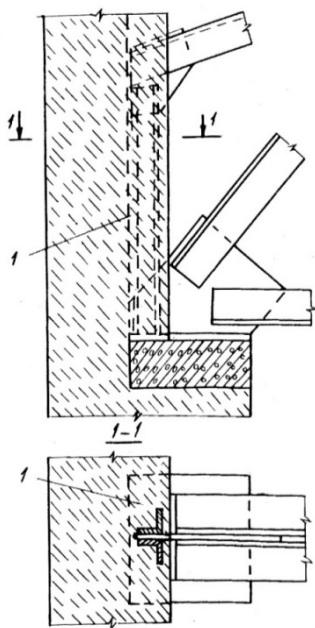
Неправильное опирание стальной фермы на кирпичную кладку:
